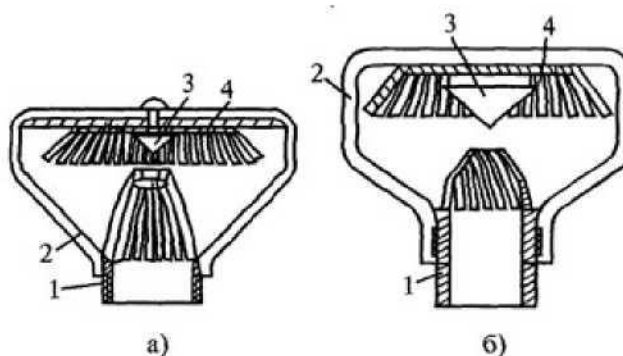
Дренчерная головка: а) с продольными щелями; б) с винтовыми щелями; 1 — корпус, 2 — дуга, 3 — рефлектор, 4 — розетка
